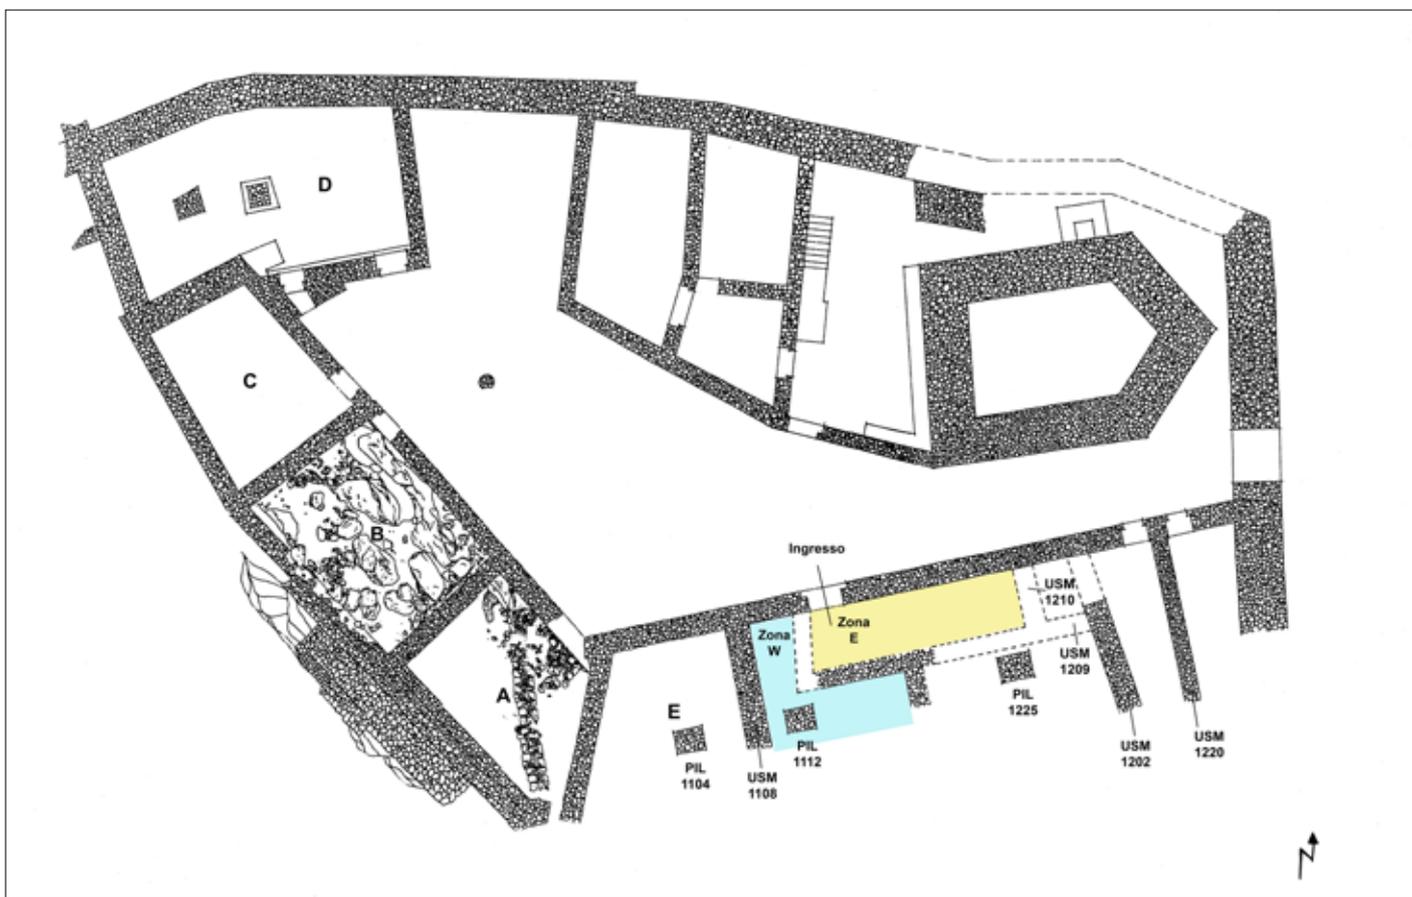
Planimetria dell'area (ril. M. Piorico 2022).
